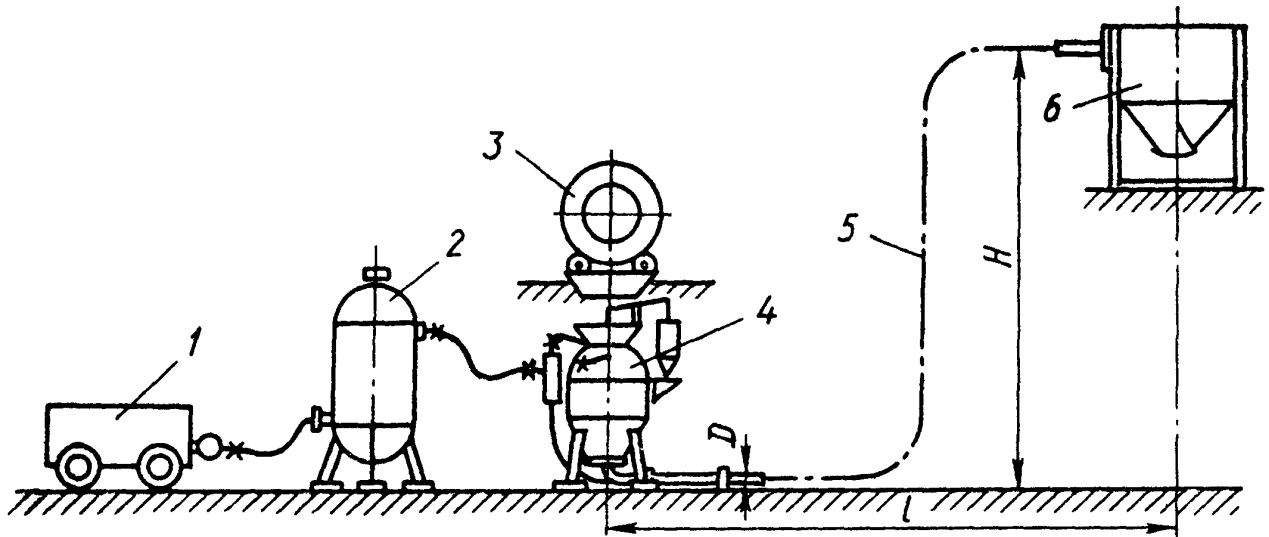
Схема I. Пневмотранспортна установка для бетонування надземних споруд: 1- пересувний компресор; 2- ресивер; 3- бетонозмішувач; 4- нагнітач; 5- бетонопровід; 6- приймальний бункер.
